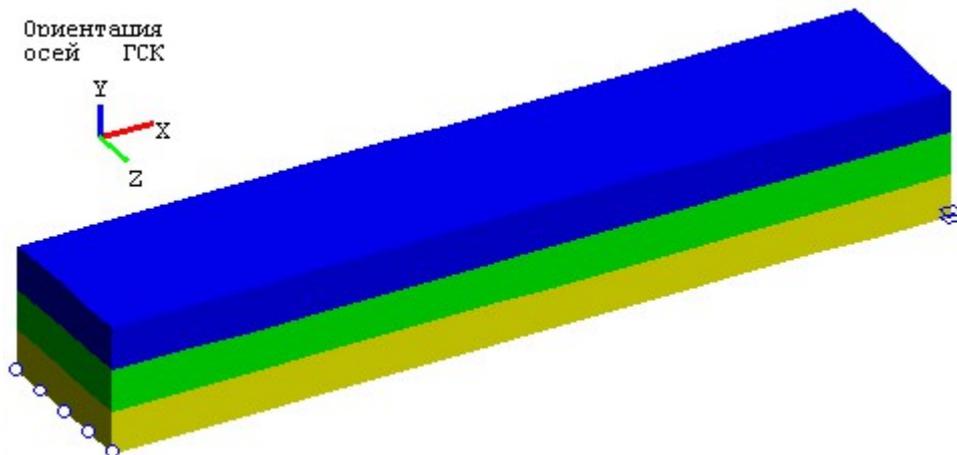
Модель железобетонной балки готовая к расчету
